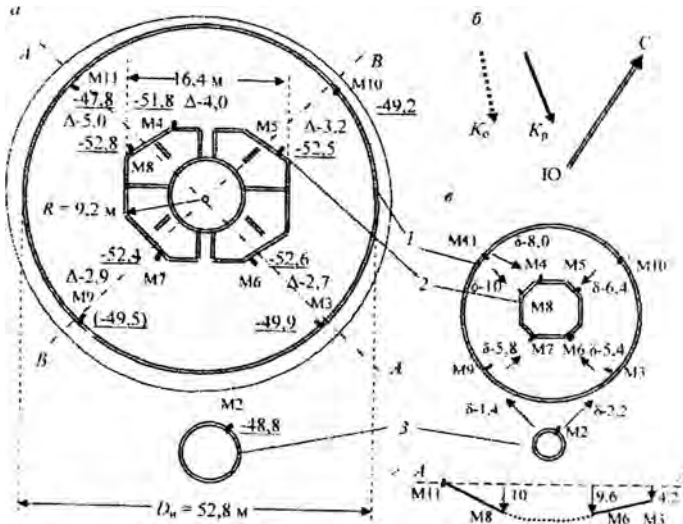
Схема размещения осадочных марок на отметке 0,0 высотного здания книгохранилища и измеренные значения их осадки:
